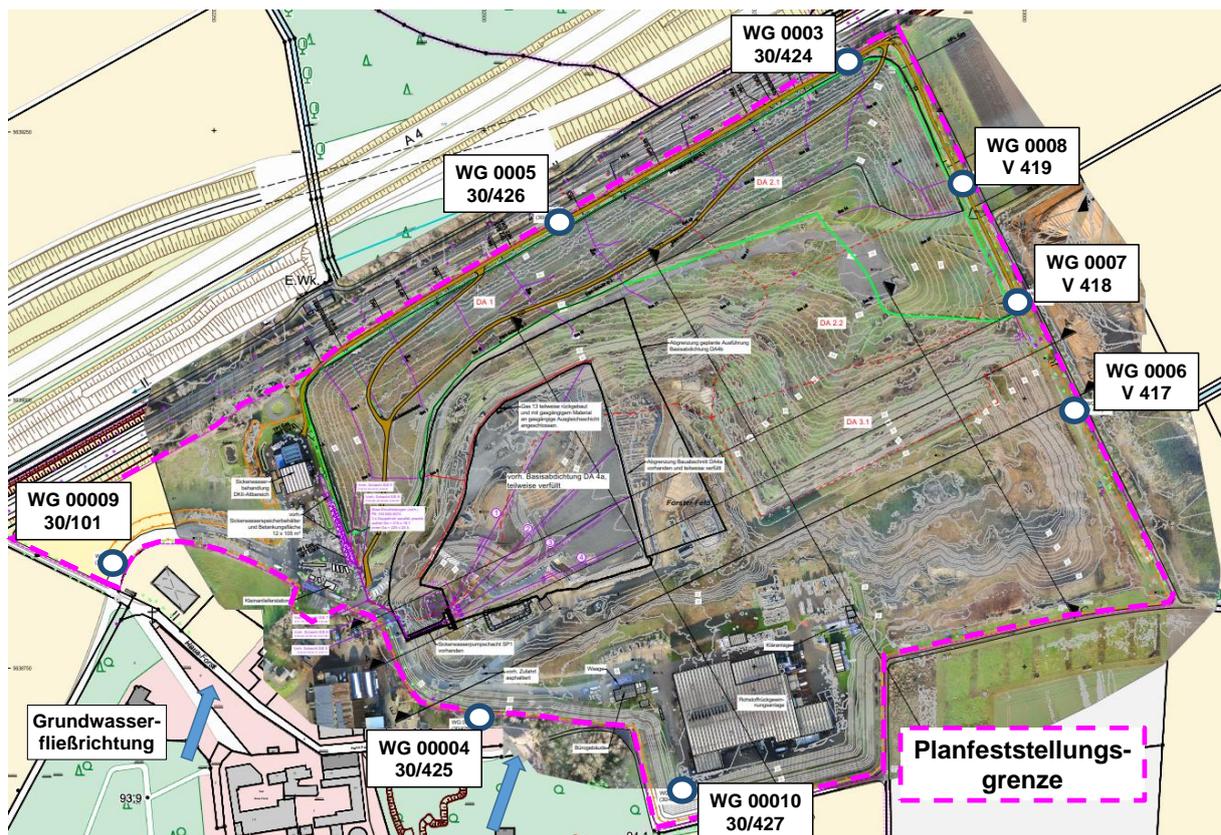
Lage Grundwassermessstellen (s. auch Lageplan GP-LP-1-3.2)
